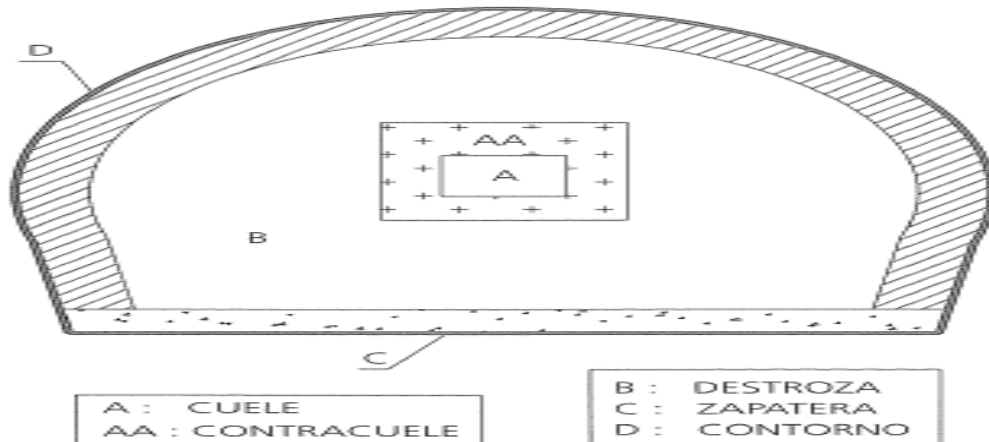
Detalle del plan de voladura (FRANQUEO)
